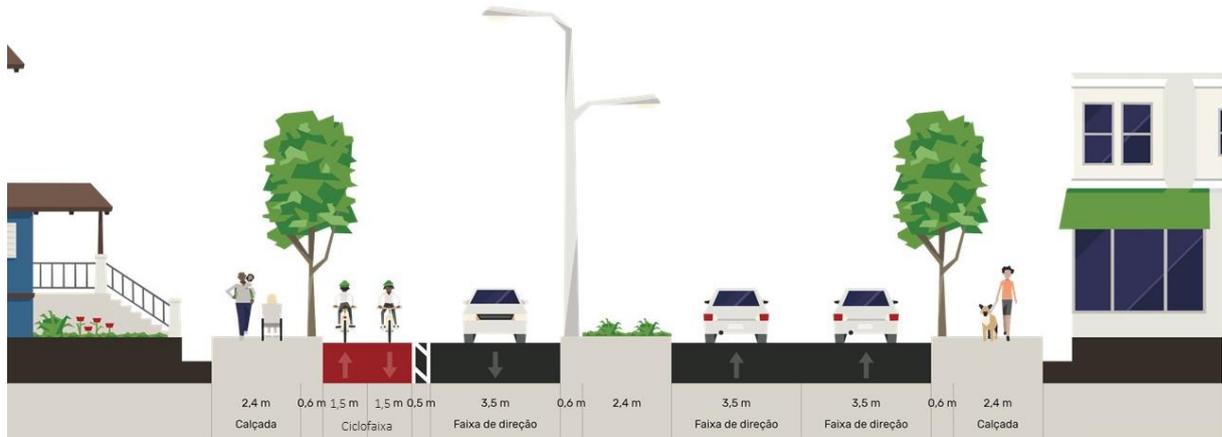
Proposta para Av. Dante Martinelli. Fonte: Streetmix. Elaboração: Polo Planejamento.
